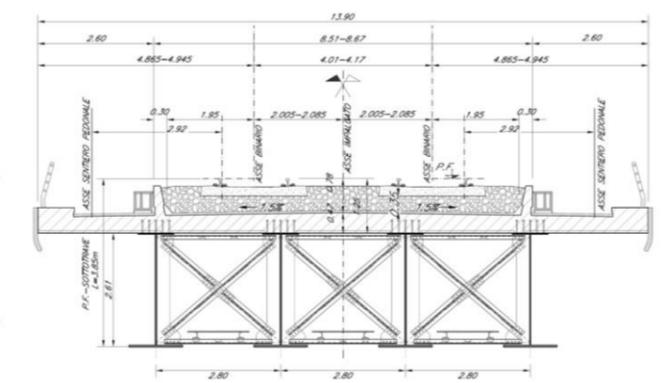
Sezione trasversale campate in acciaio-clt L=40 m - Doppio binario
